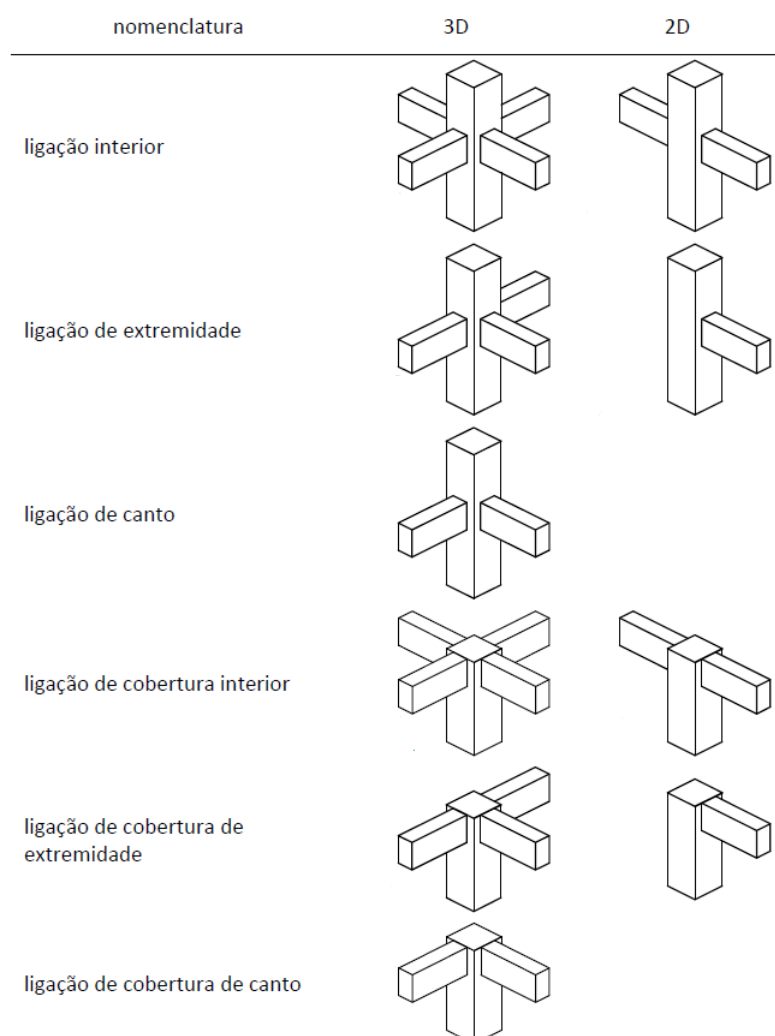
Tipologias de ligações viga-pilar em pórticos ortogonais planos e tridimensionais, em função do número e disposição das peças lineares adjacentes (Costa, 2013)
